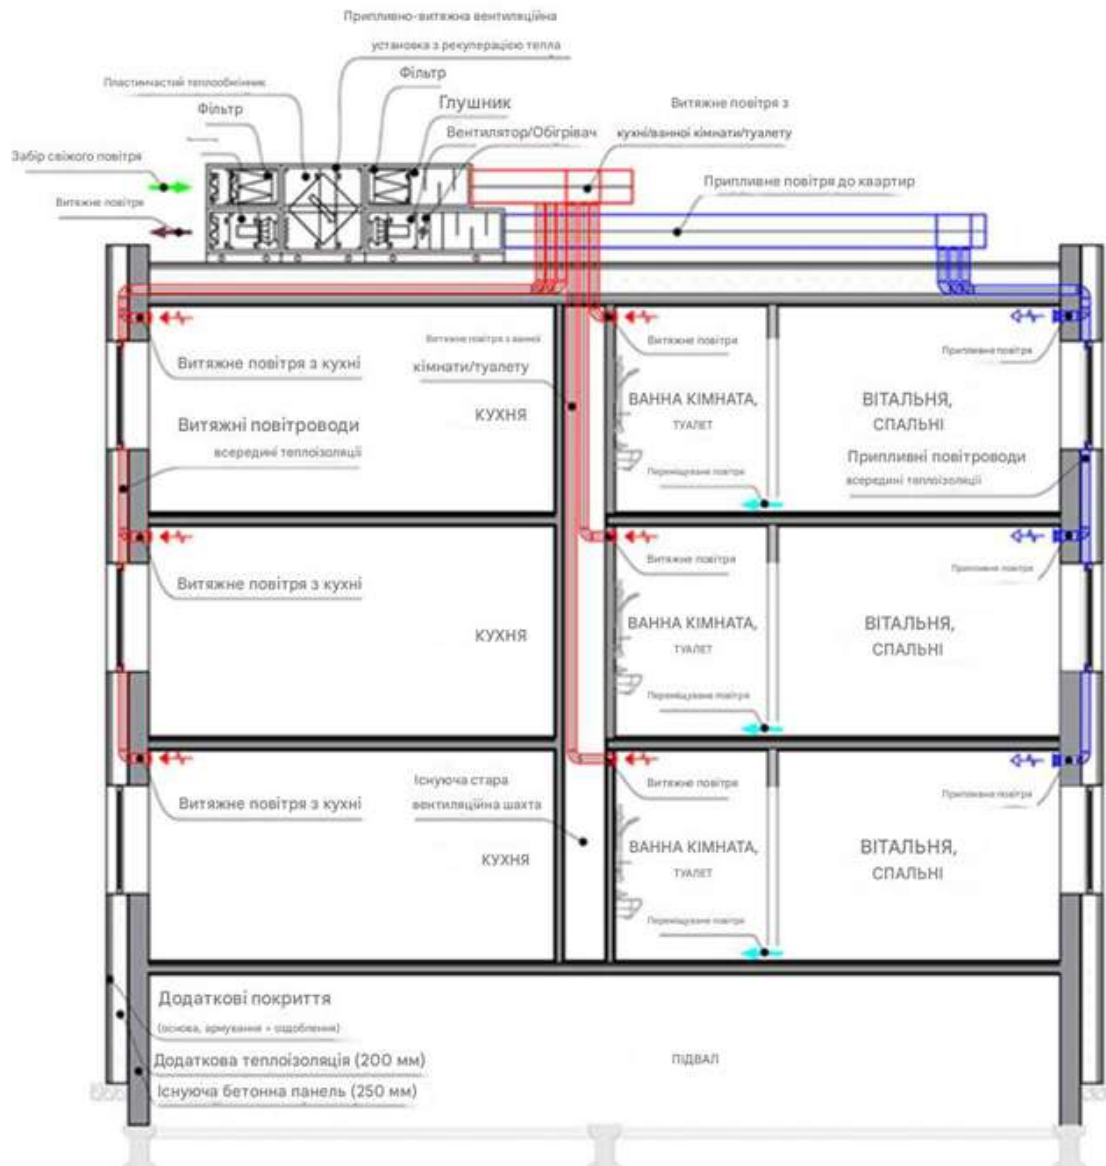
Схема інтеграції вентиляційних каналів у фасад будинку
